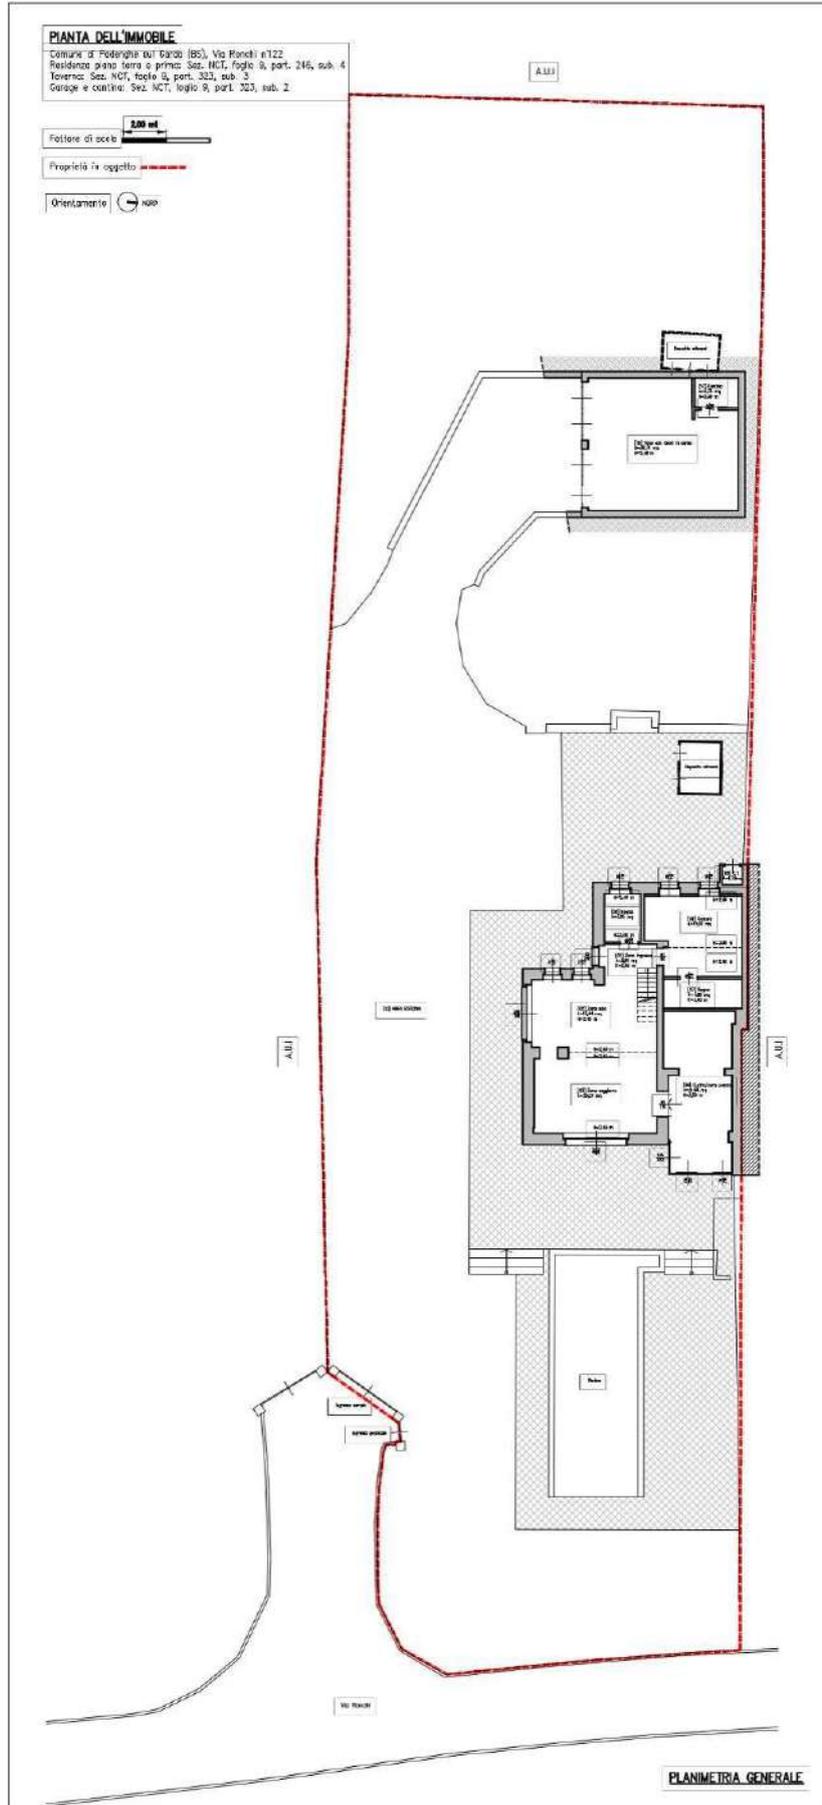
Planimetria generale del lotto e perimetrazione proprietà
